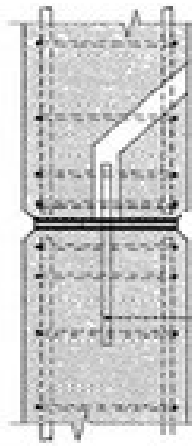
Modelo de ligação pilar-pilar através de rótula (STUPRÉ, 1981).
